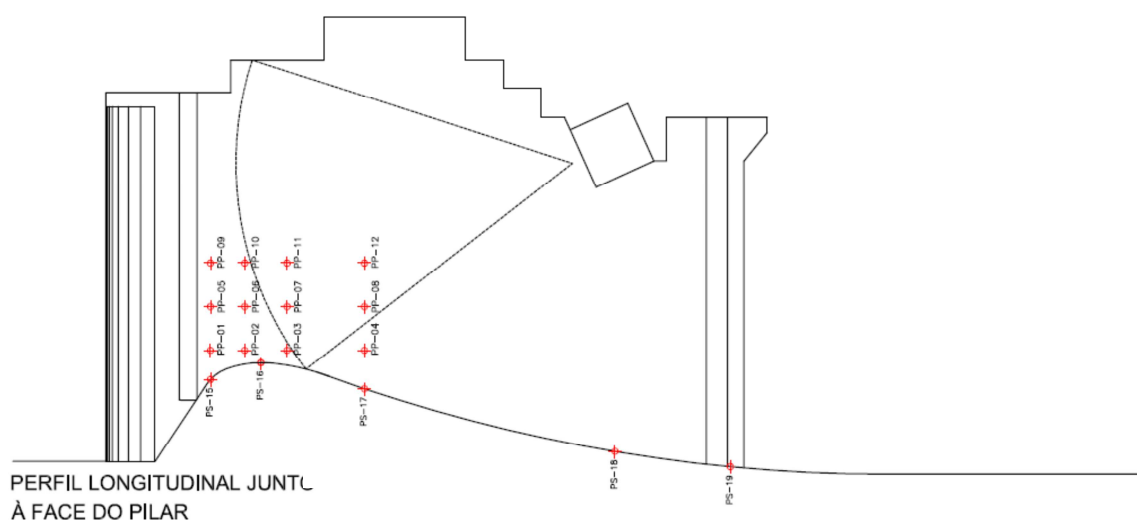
Localização dos piezômetros no modelo físico - junto ao pilar
